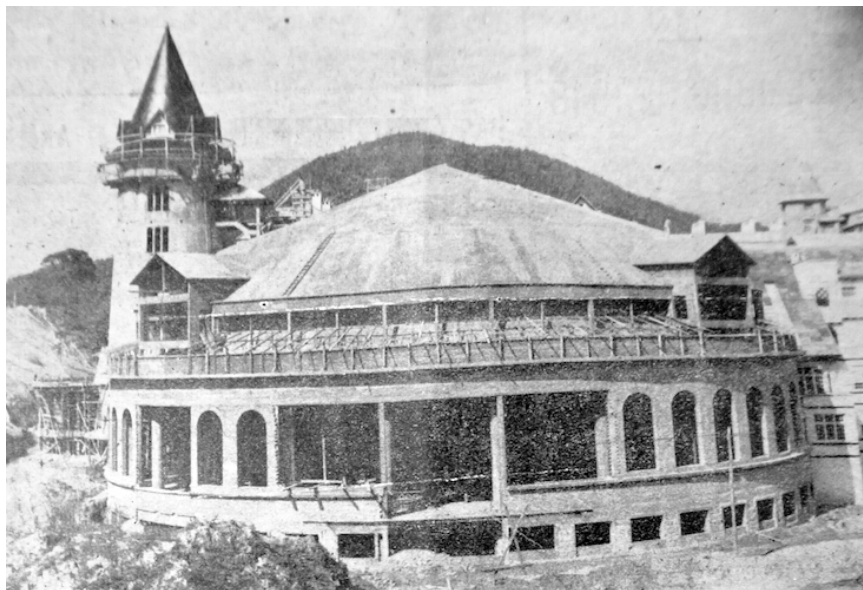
Vista parcial da construção do Hotel Quitandinha. Cúpula do Salão Social FONTE: CONCRETO, 1943.
